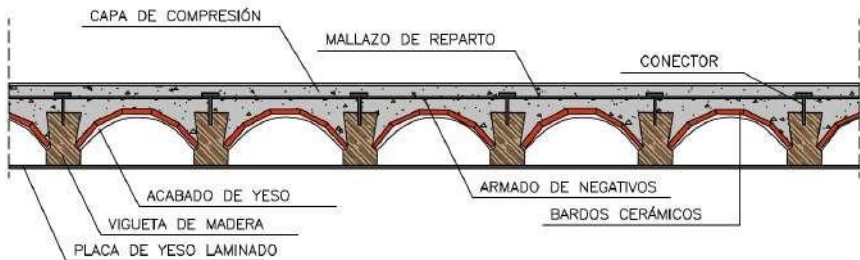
Detalle intervención refuerzo con conectores vivienda. Fuente propia
